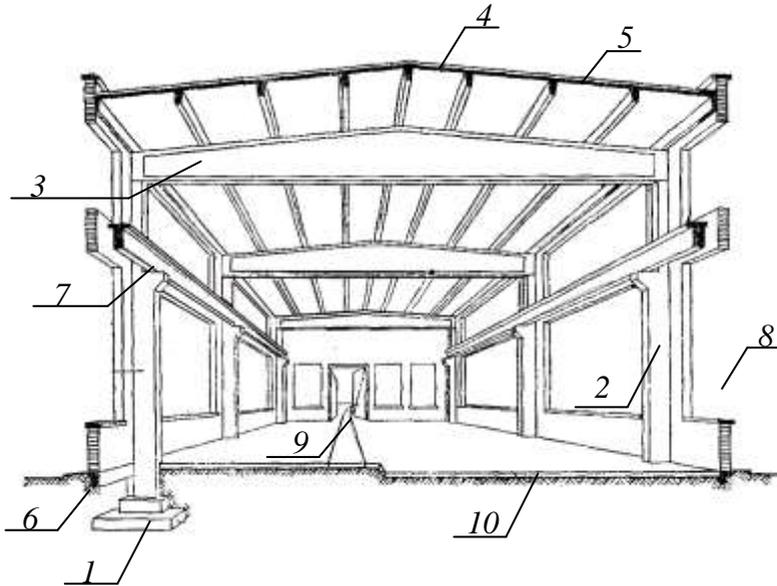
Конструктивные элементы одноэтажного производственного здания: 1 — фундамент; 2 — колонна; 3 — стропильная балка; 4 — плита покрытия; 5 — кровля; 6 — фундаментная балка; 7 — подкрановая балка; 8 — окно; 9 — ворота; 10 — пол
